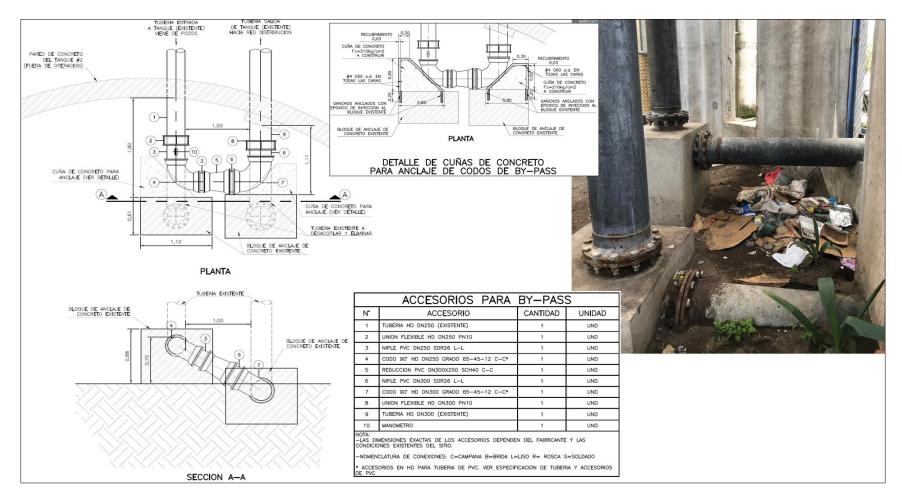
Detalle constructivo del By-Pass en la tubería de entrada y salida existente del Tanque #2.
